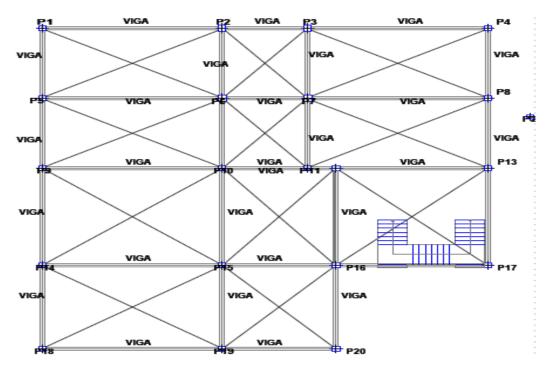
Ilustração do arranjo estrutural para o bloco 1 (RC E 1º Andar).
